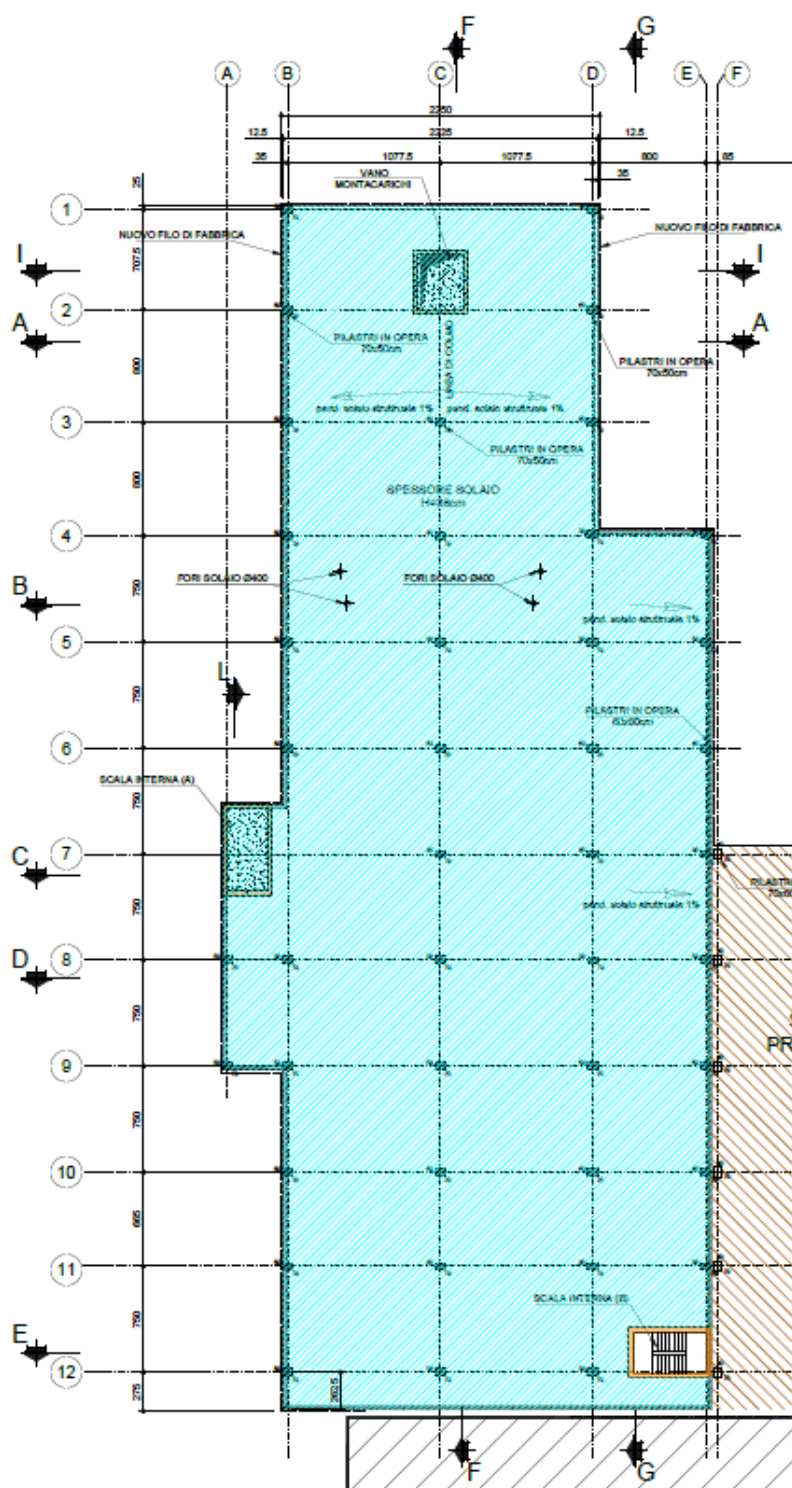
Planimetria piano P3 (copertura) - Fabbricato ex. Piemonte
